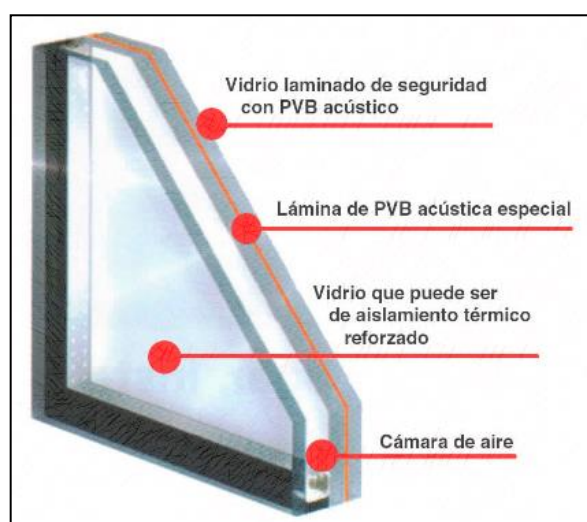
Aislación acústica – vidrio y lamina PVB. Recuperado de Chuquisala (2014)
